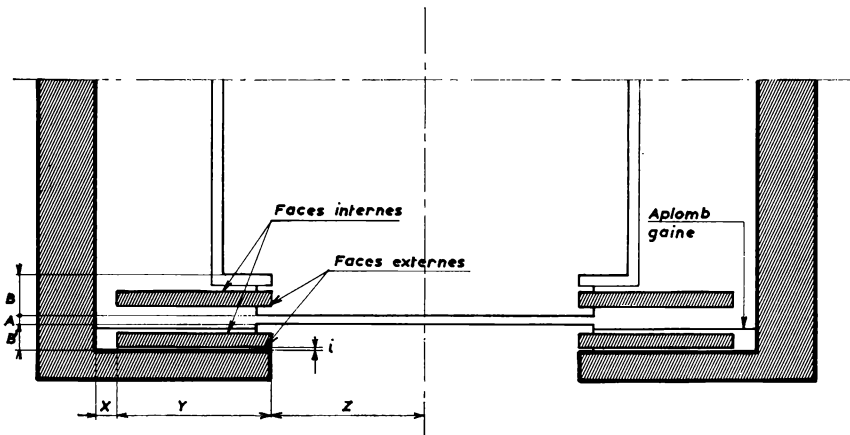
Travaux de maçonnerie pour implantation de porte coulissante à deux vantaux à ouverture centrale (même porte sur cabine).
